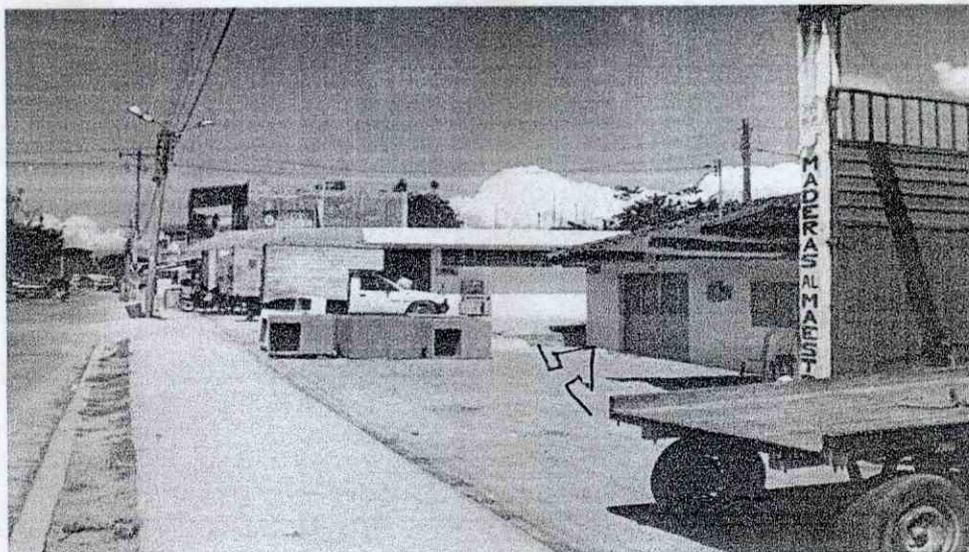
VISTA DE LA CALLE 21 SUR DESDE LA CARRERA 3 HACIA LA CARRERA 4
